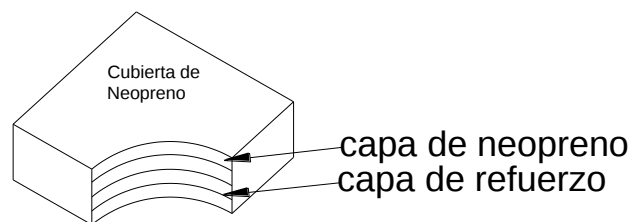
Detalle de un apoyo Elastomérico.
